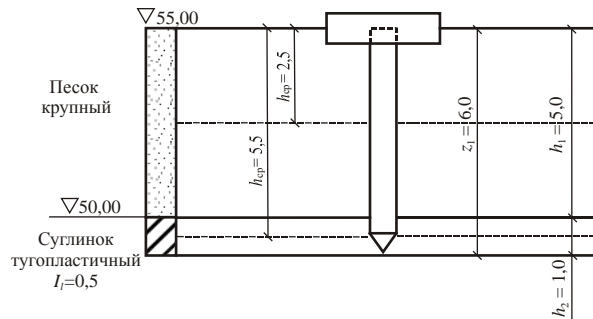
Расчетная схема основания свайного фундамента
